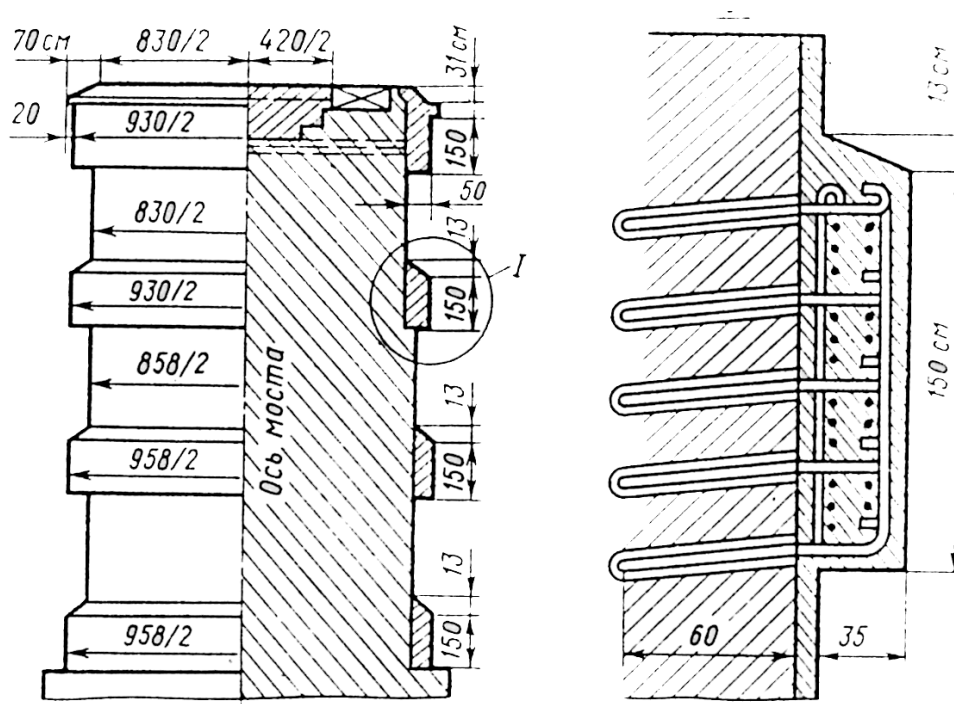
Схема усиления промежуточной опоры железобетонными поясами
